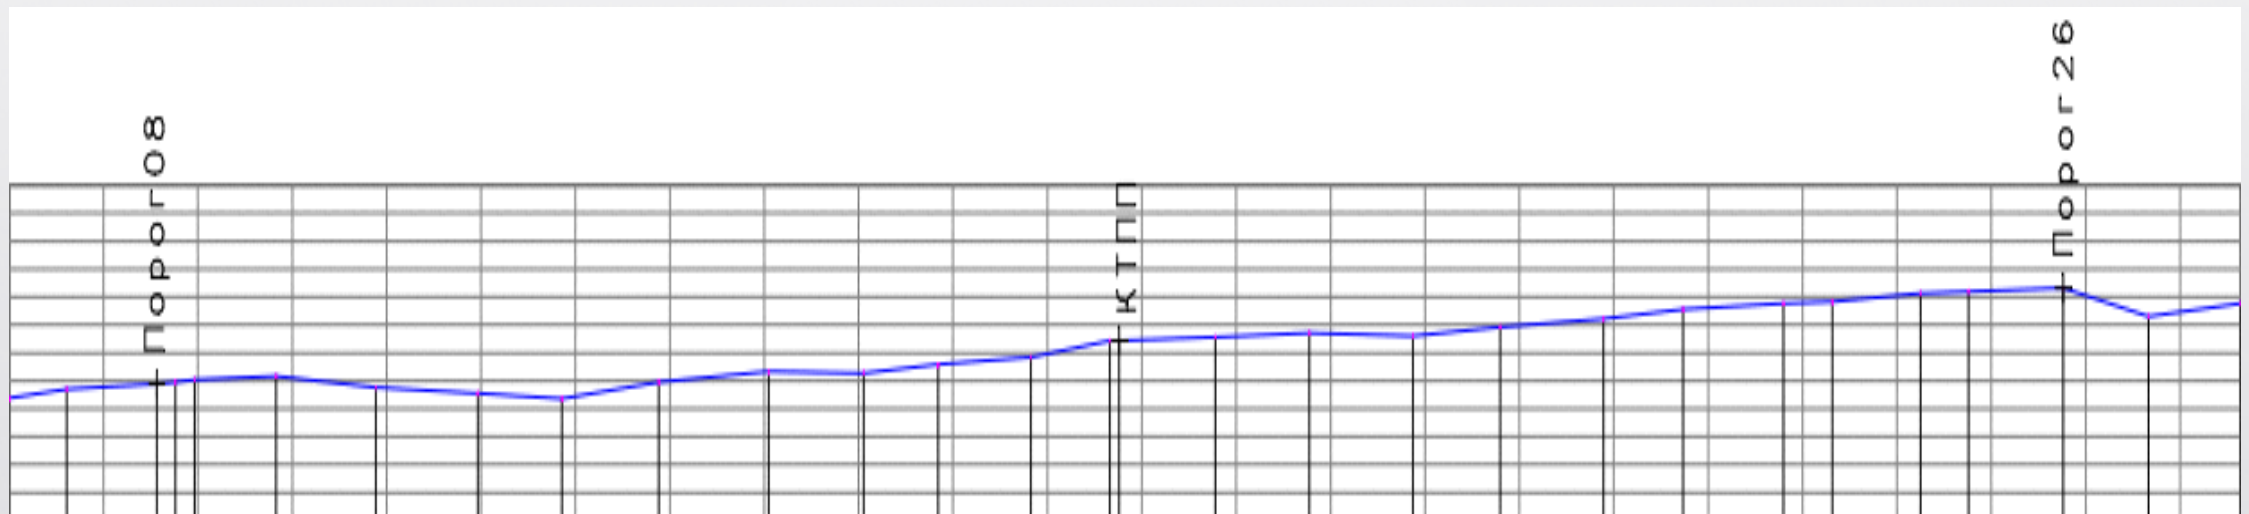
Продольный профиль грунтовой взлетно-посадочной площадки
